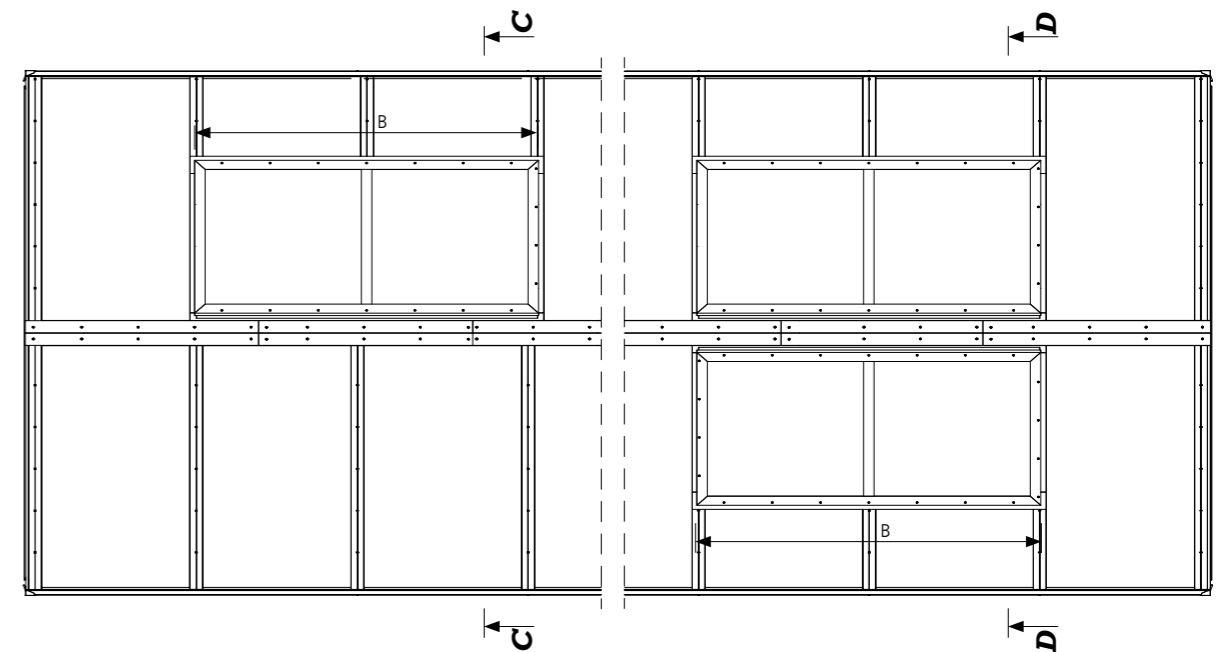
Draufsicht von einem satteldachförmigen Lichtband Typ mcr PROLIGHT mit einer Lüftungs-Einzelclappe und einer Lüftungs-Doppelclappe
